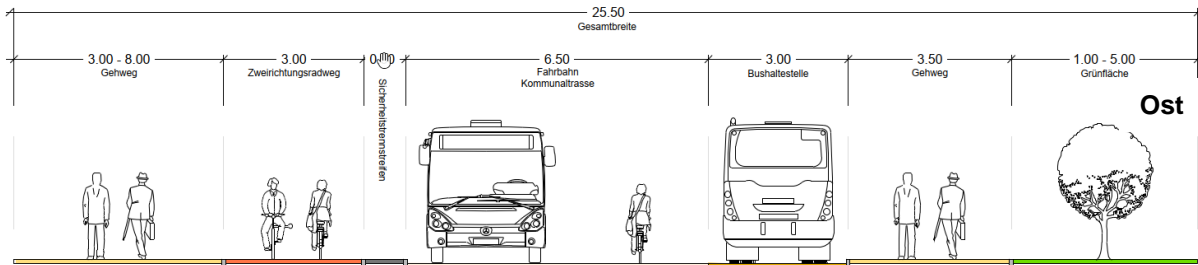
Geplanter Querschnitt Planstraße A (südlicher Abschnitt)
